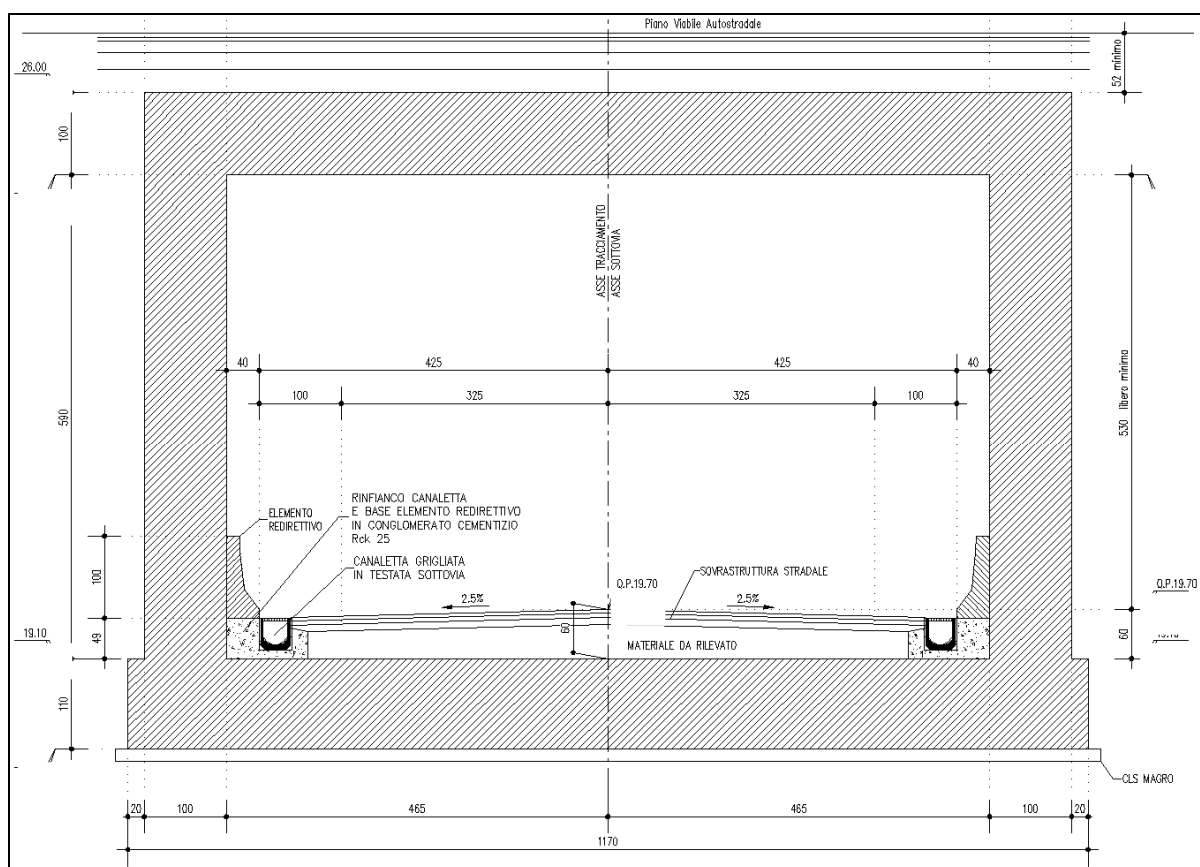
SEZIONE TRASVERSALE DEL SOTTOVIA
